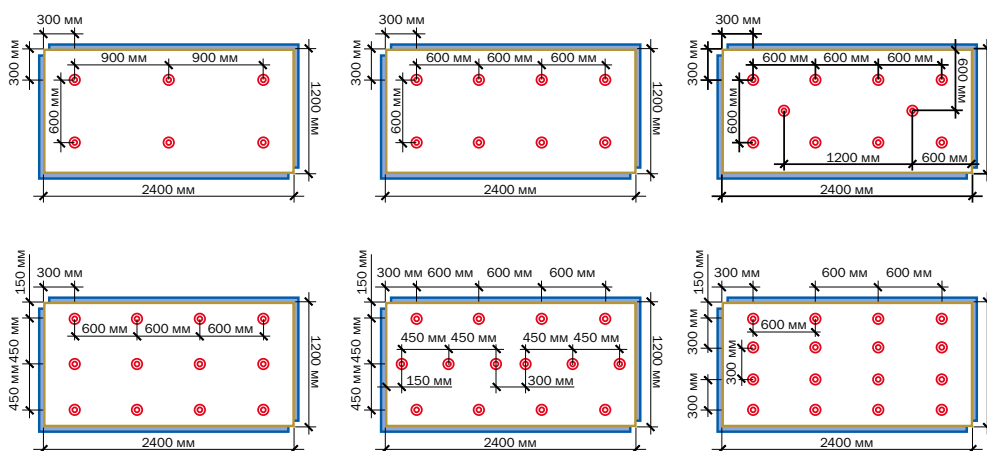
Схема крепления теплоизоляционных плит из пенополиизоцианурата при индукционном способе крепления полимерной мембраны
